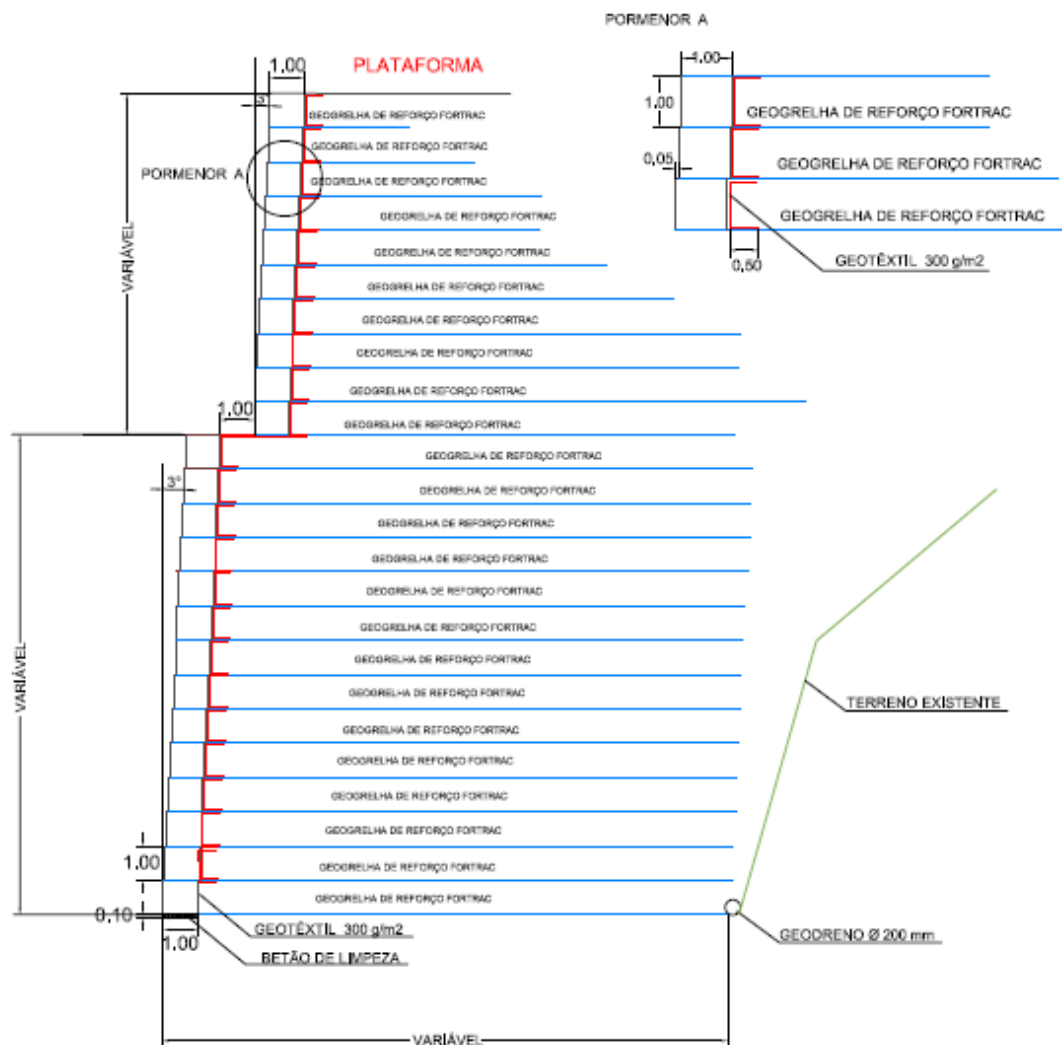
Sección transversal de Muro de Gaviones Reforzado con geomallas
